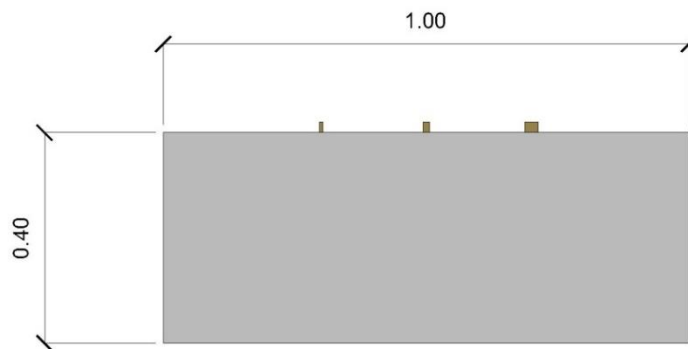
Alçado longitudinal da Viga A (dimensões em m)
